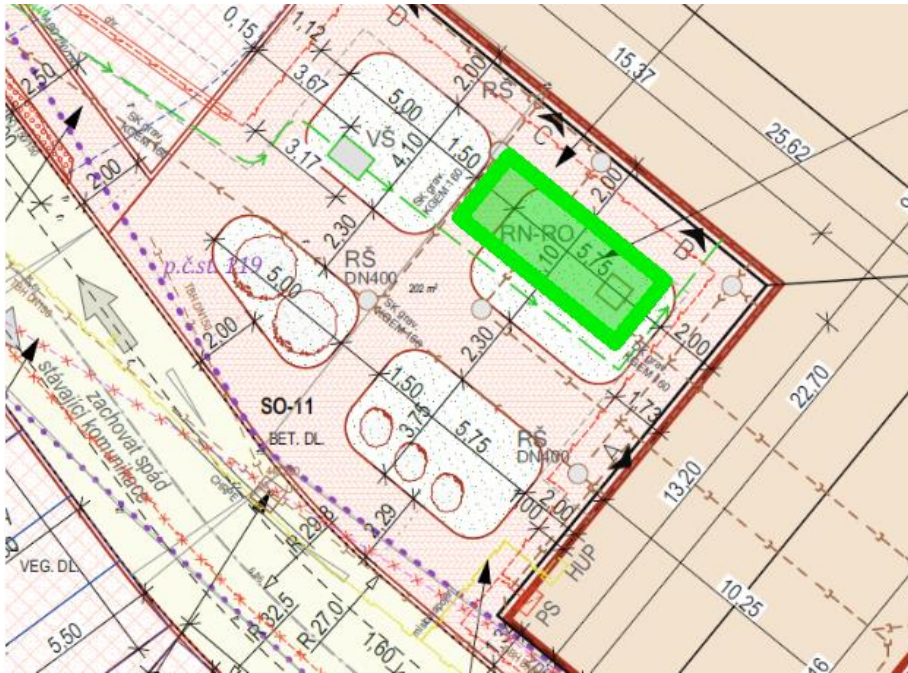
Výřez ze situace – zvýrazněna plotová stěna, upraveno [3]
